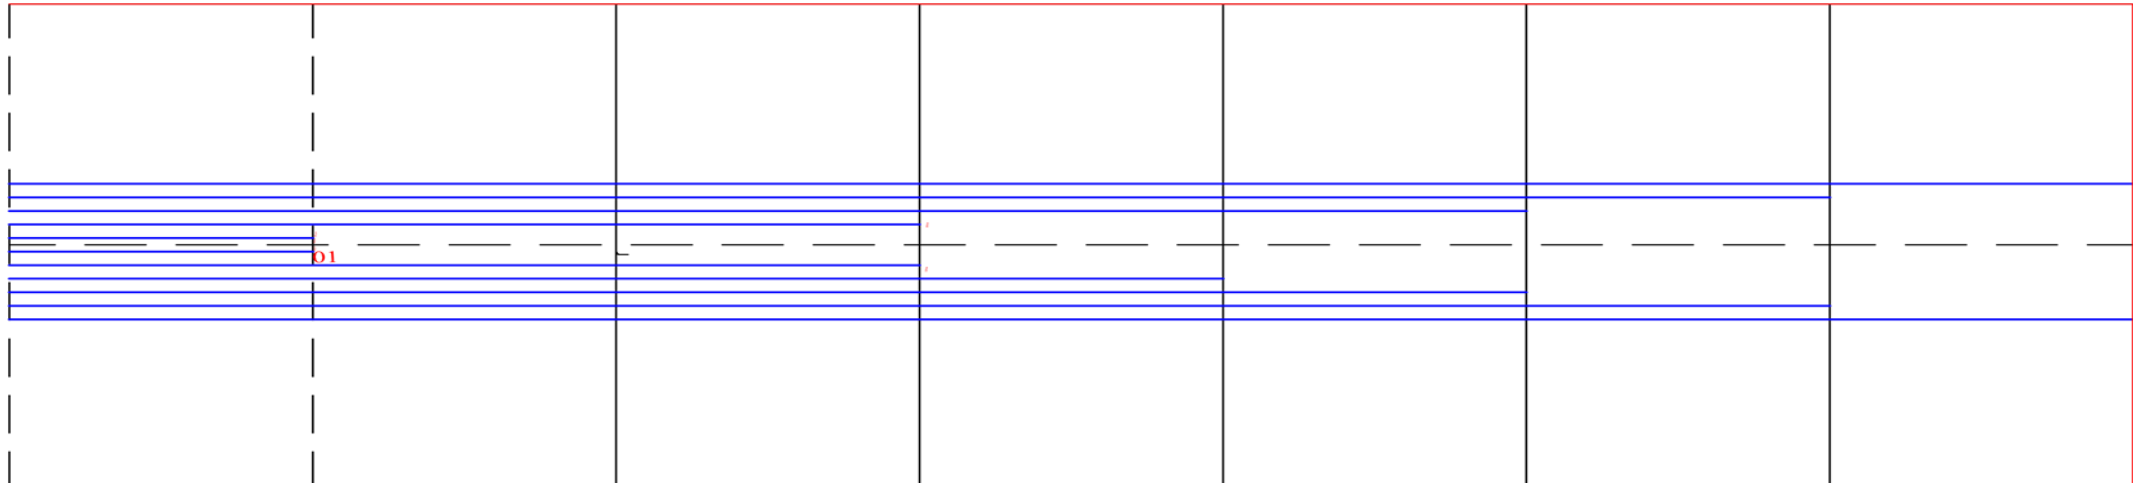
Vue en plan des câbles de fléau (1 :150)
